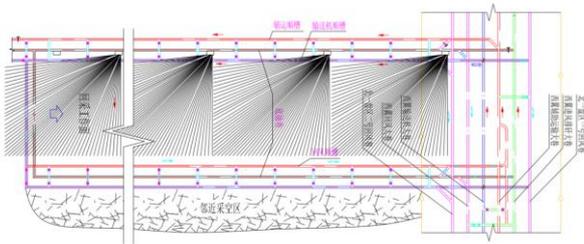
综采工作面千米定向钻孔区域平面布置示意图(单位:m)
